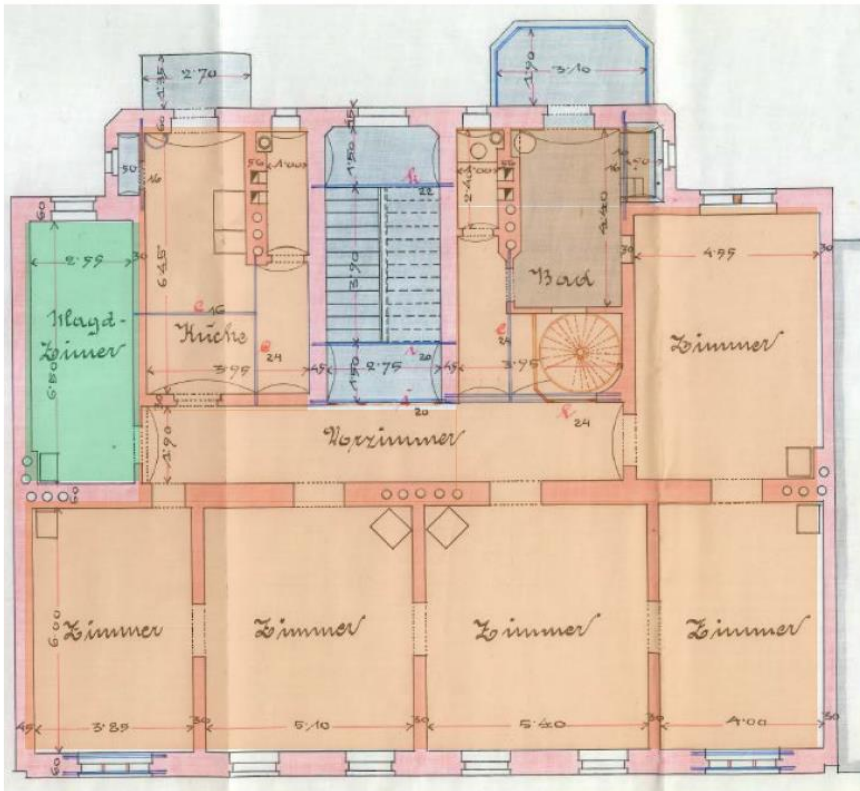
Grundriss eines Innenstadtpalais im ersten Obergeschoß⁶⁰
